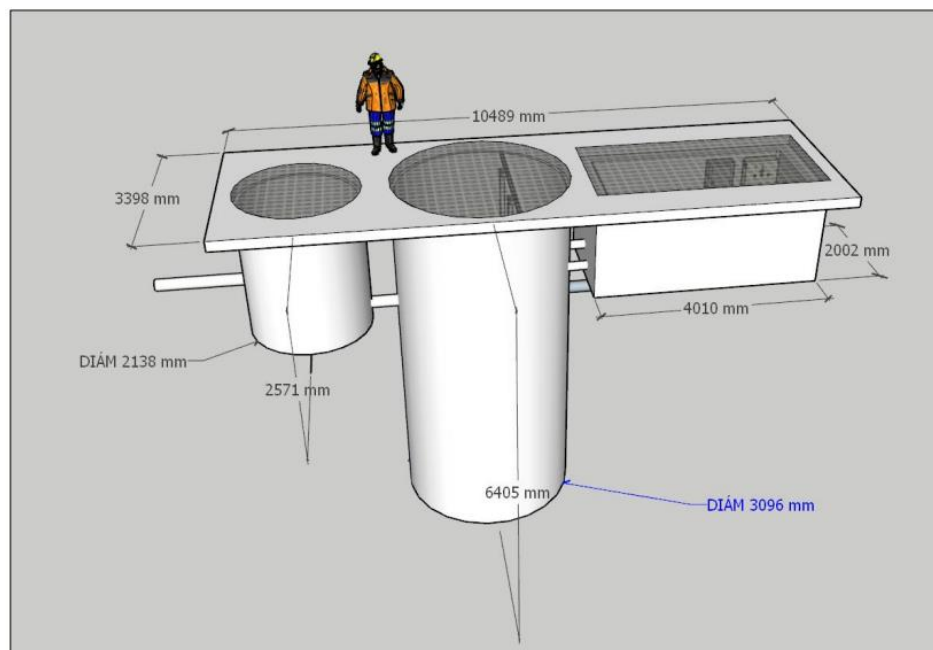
Planta de levantamiento de estación bombeo saneamiento.
